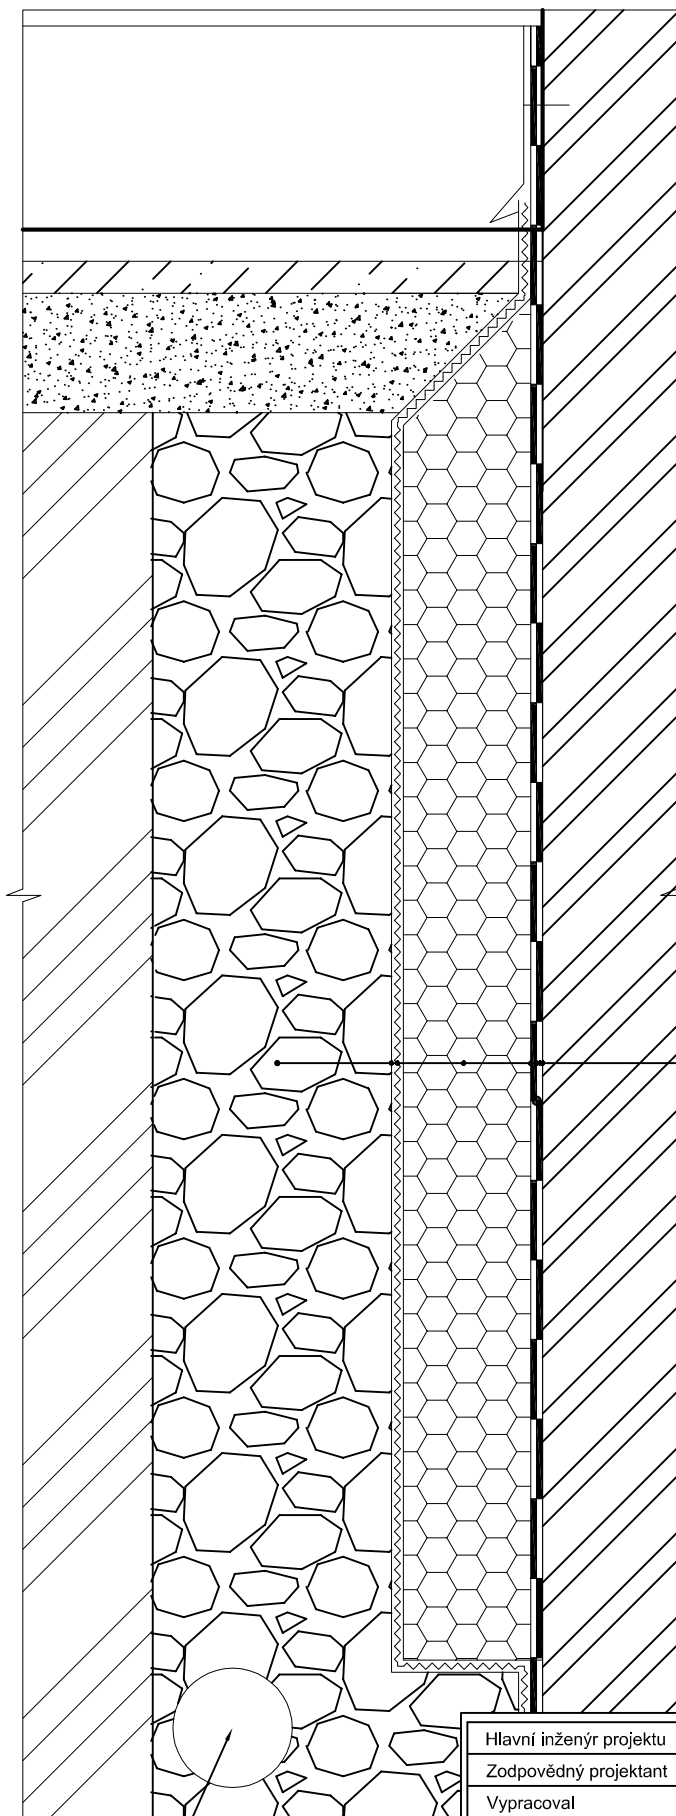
# DETAIL H - ZATEPLENÍ SUTERENNÍHO ZDIVA M 1:10
